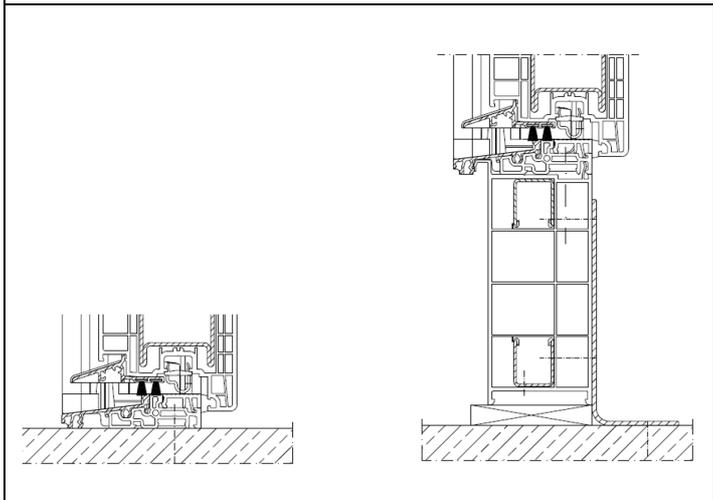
Montaggio della soglia (direttamente sul pavimento e sull'allargamento)
